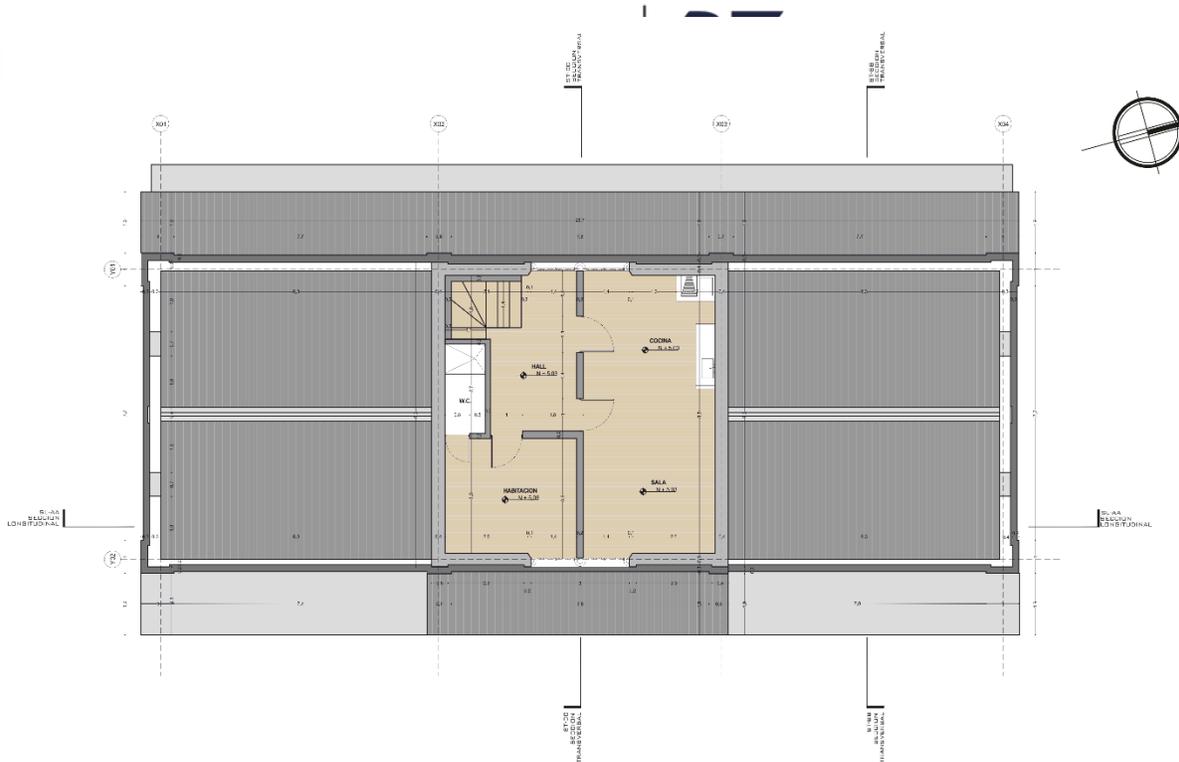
Planta arquitectónica segundo nivel, Estación del ferrocarril Sur.
